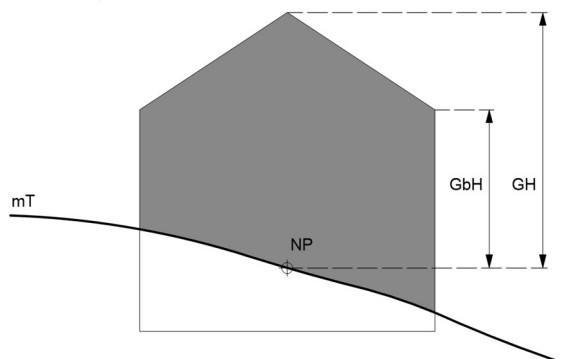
Gesamt- und Gebäudehöhe Schrägdach
